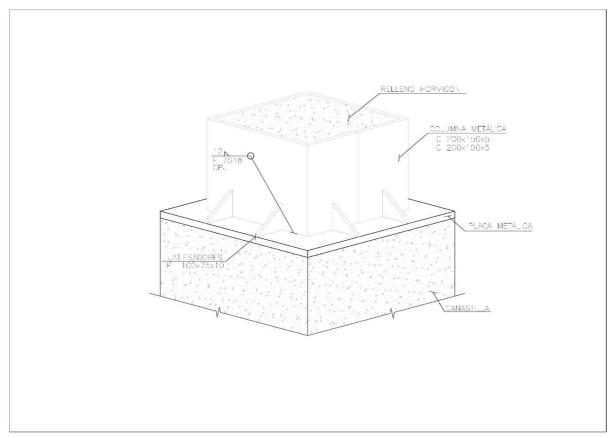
Encuentro cimiento de hormigón con columna metálica
